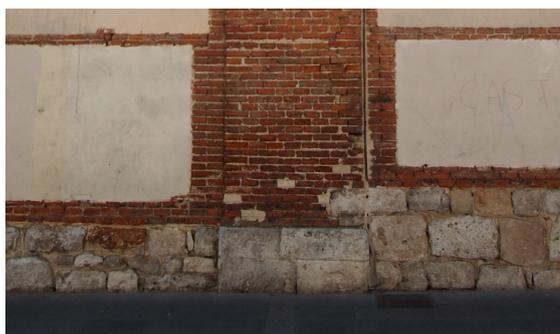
Detalle del machón con pilastra sobre zócalo de piedra.
